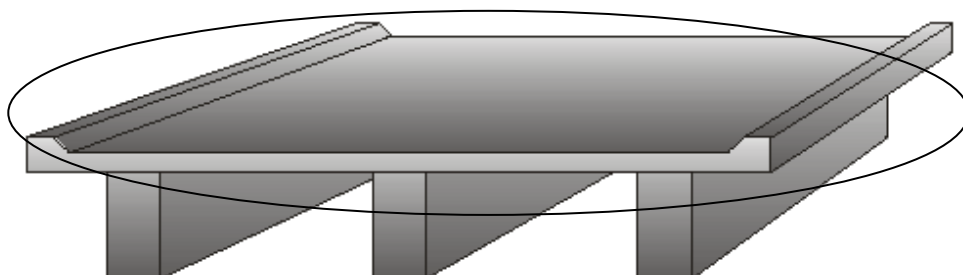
Posizione dell'Elemento Standard nella struttura (BRIME – D14).
